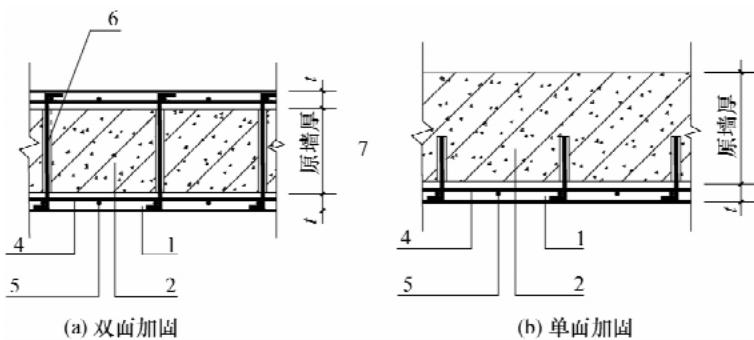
配筋高延性混凝土面层加固钢筋混凝土剪力墙构造
